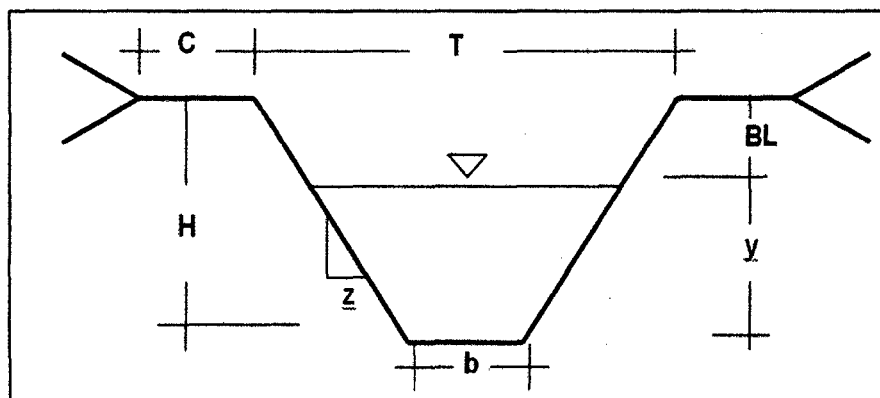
Elementos geométricos de la sección transversal de un canal
